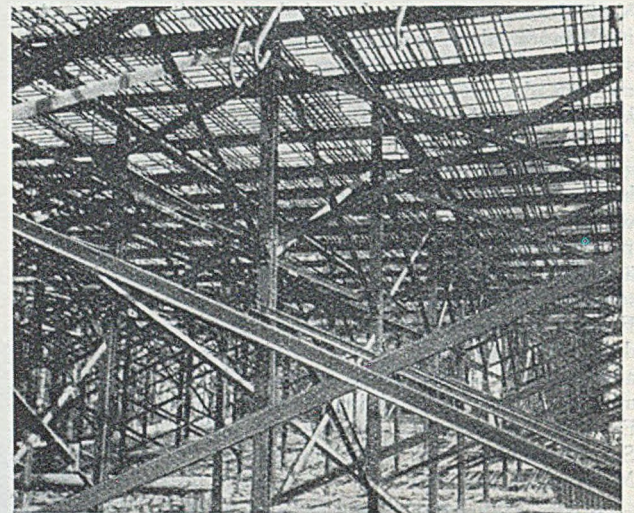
Bewehrungsgerüst mit oberer Sohlenbewehrung.
